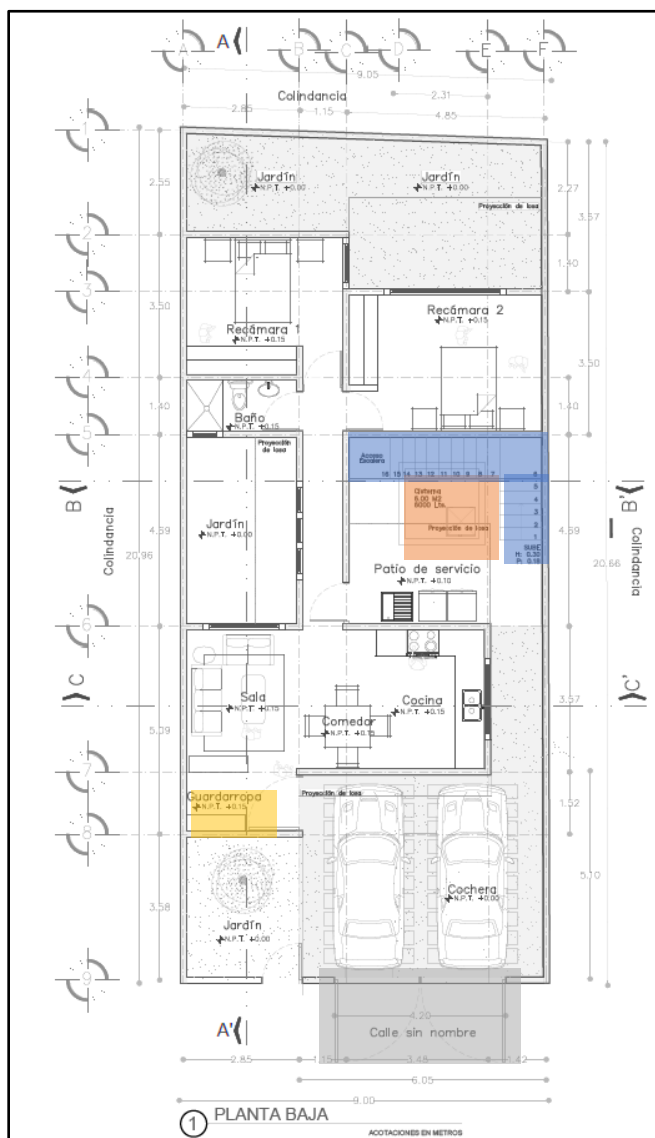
Plano arquitectónico Planta Baja modificaciones. Elaboración propia. (YPHC 2025)
